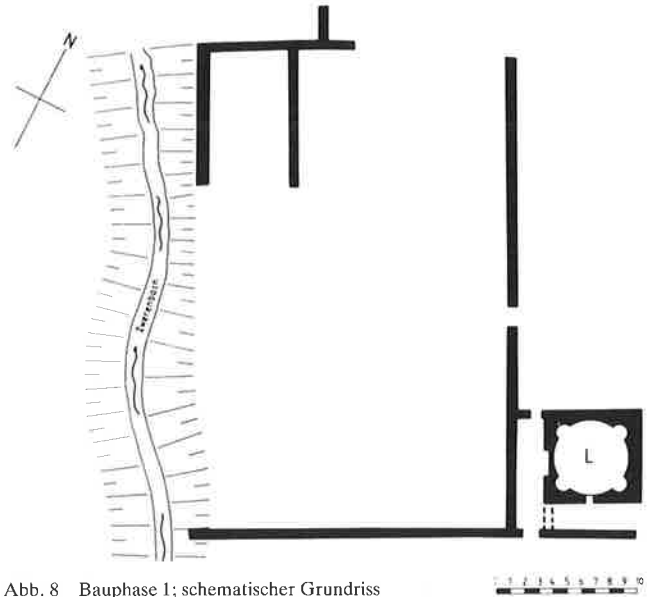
Bauphase I; schematischer Grundriss
